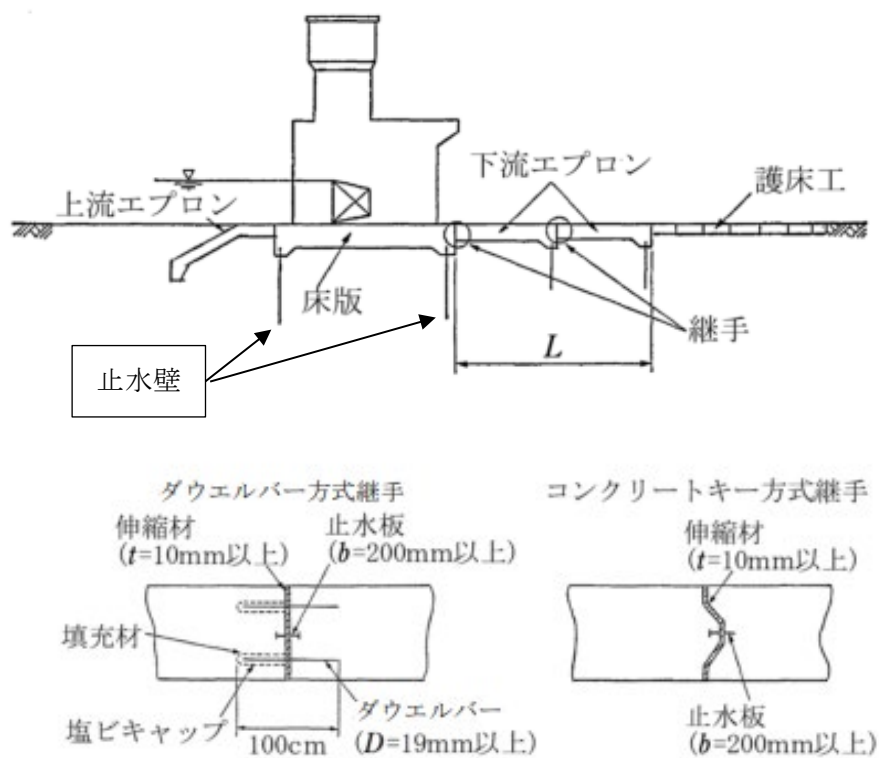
基礎の詳細図（止水壁の概要及びエプロンの継目詳細図）
